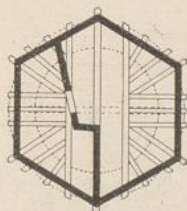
Grundriss des Fachwerkgeschosses.
